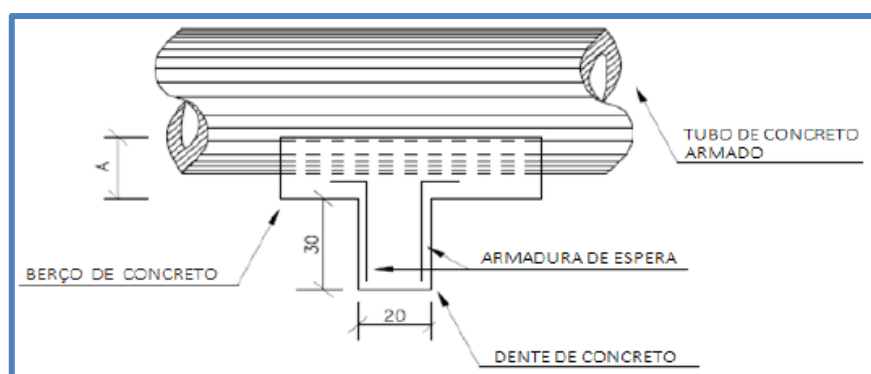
Vista lateral do corpo do bueiro tubular de concreto
